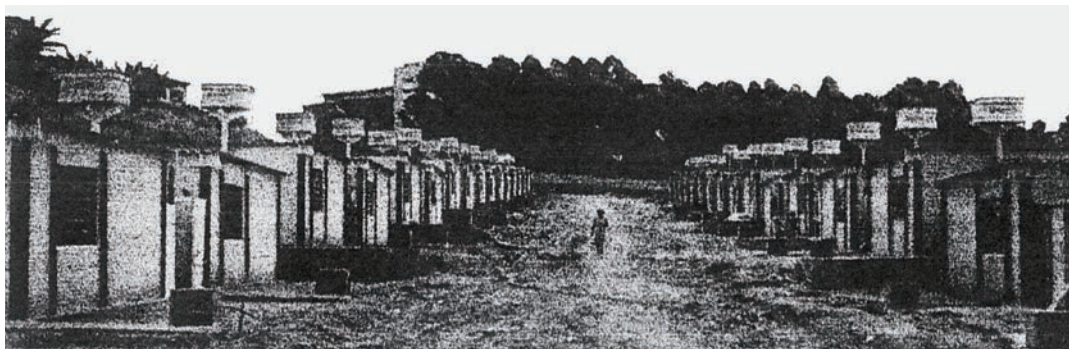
FOTO DE IMPLANTAÇÃO DE EMBRIÕES DO PROJETO MODELAR
